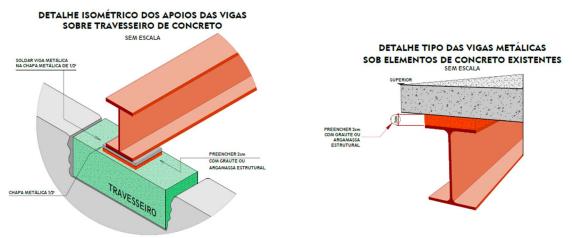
Detalhes do apoio das vigas e do encontro da viga metálica com o reforço metálico.
